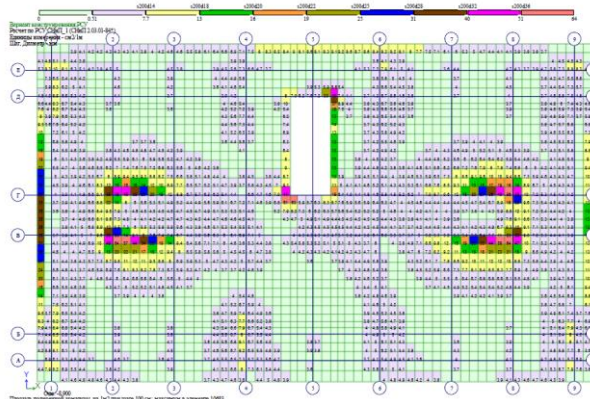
Площадь поперечной арматуры на 1м2 при шаге 100 см
